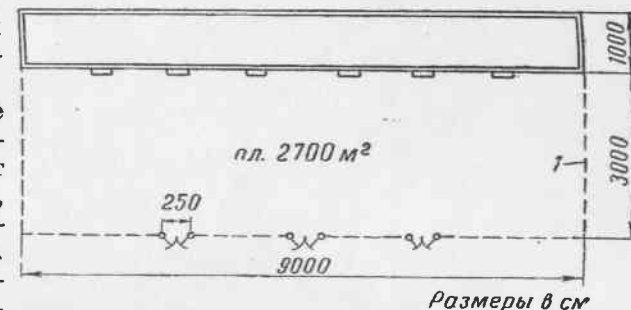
Схематический план расположения левад при конюшне на 100 жеребят: 1—ограждение из жердей высотой 160 см.
